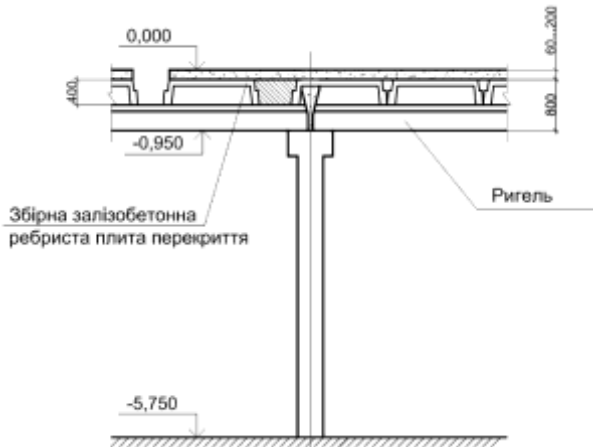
Загальний вигляд конструкції збірного залізобетонного надпідвального перекриття в місці обпирання на несучу збірну залізобетонну колону підвального поверху
